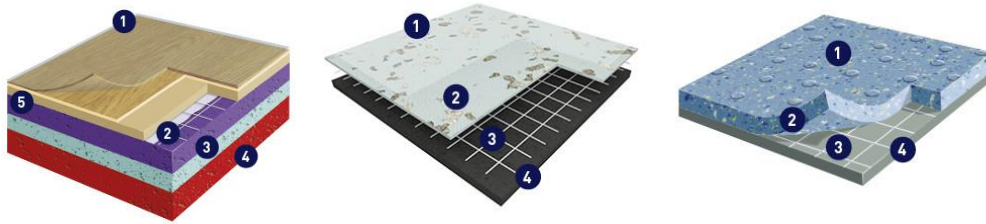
Pavimento vinílico (Fuente: catálogo GERFLOR)
